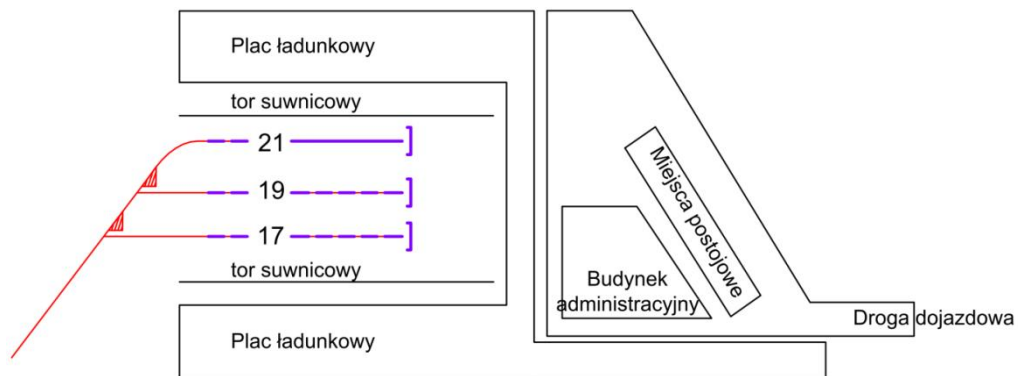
Schemat terminala – Alternatywa 1 wariantu 1
